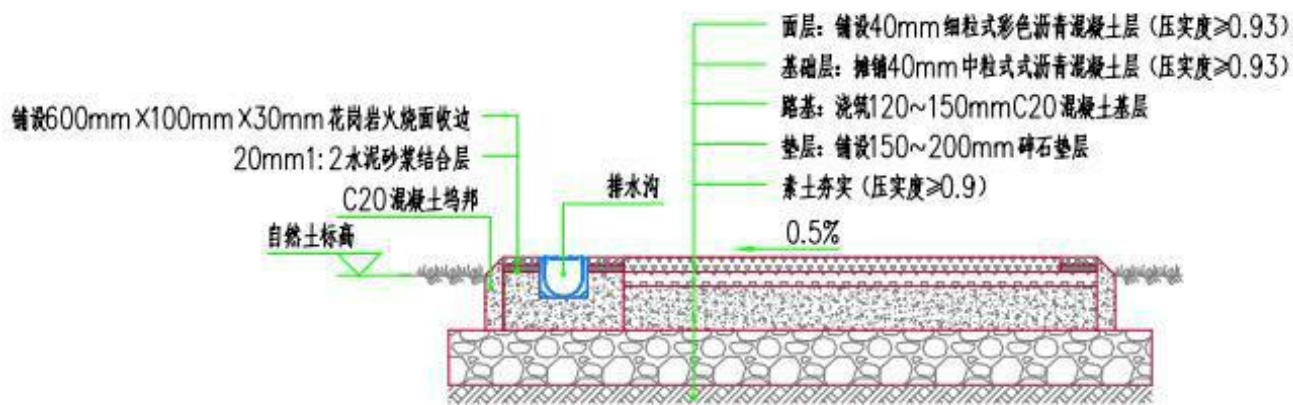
透水沥青混凝土健身步道参考平面图（单向标准段）
